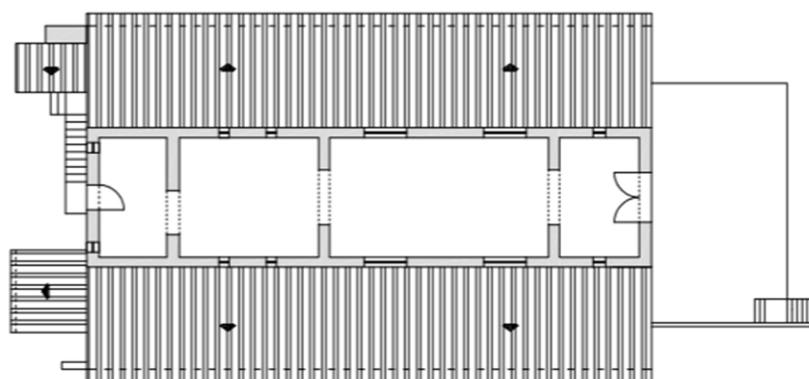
Levantamento da definição geométrica, Planta do piso superior
